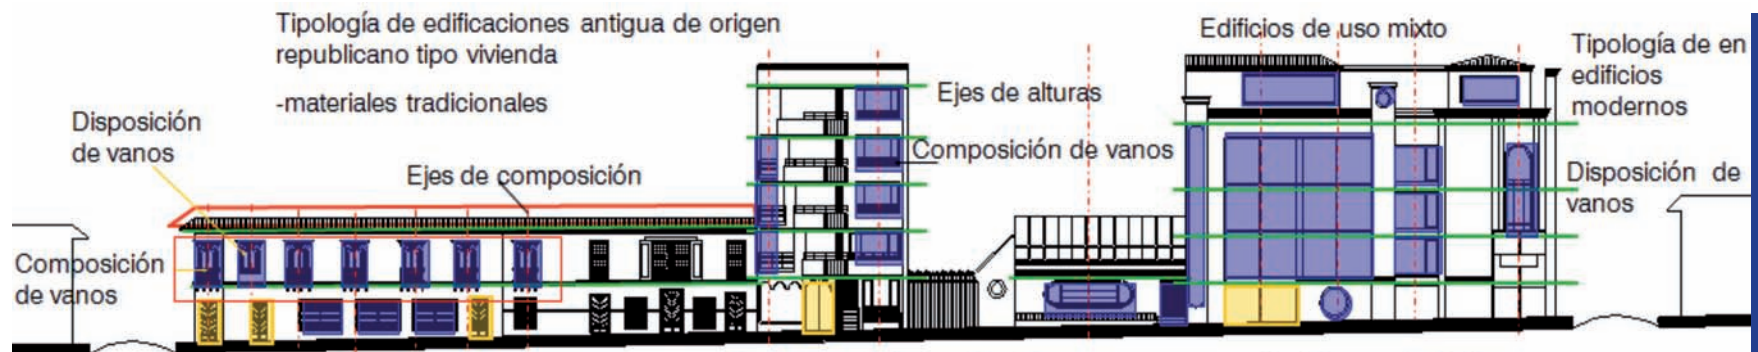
//Levantamiento de fachada, Cra 23 entre calles 20 y 19 - área de estudio//
